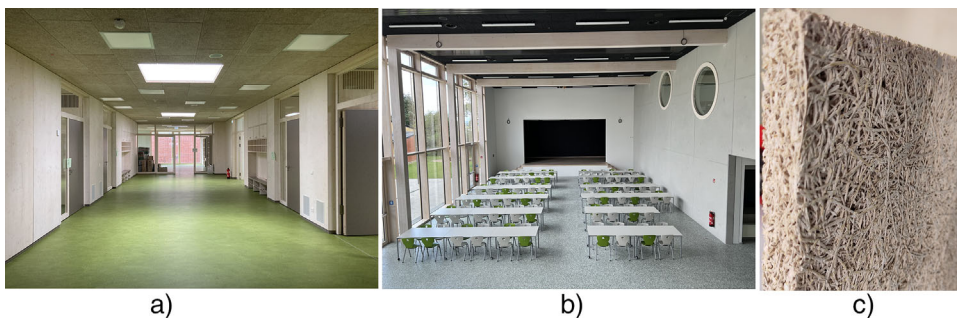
Betonwerkstoffe in dem Schulgebäude; a) zementgebundene Deckenplatten im Forum, b) zementgebundene Deckenplatten mit schwarzem Farbanstrich an der Mensadecke, Betonwand (mit Rundfenstern) und Betonwerkstein auf dem Fußboden der Mensa, c) Holzfaser-Struktur der Deckenplatten
